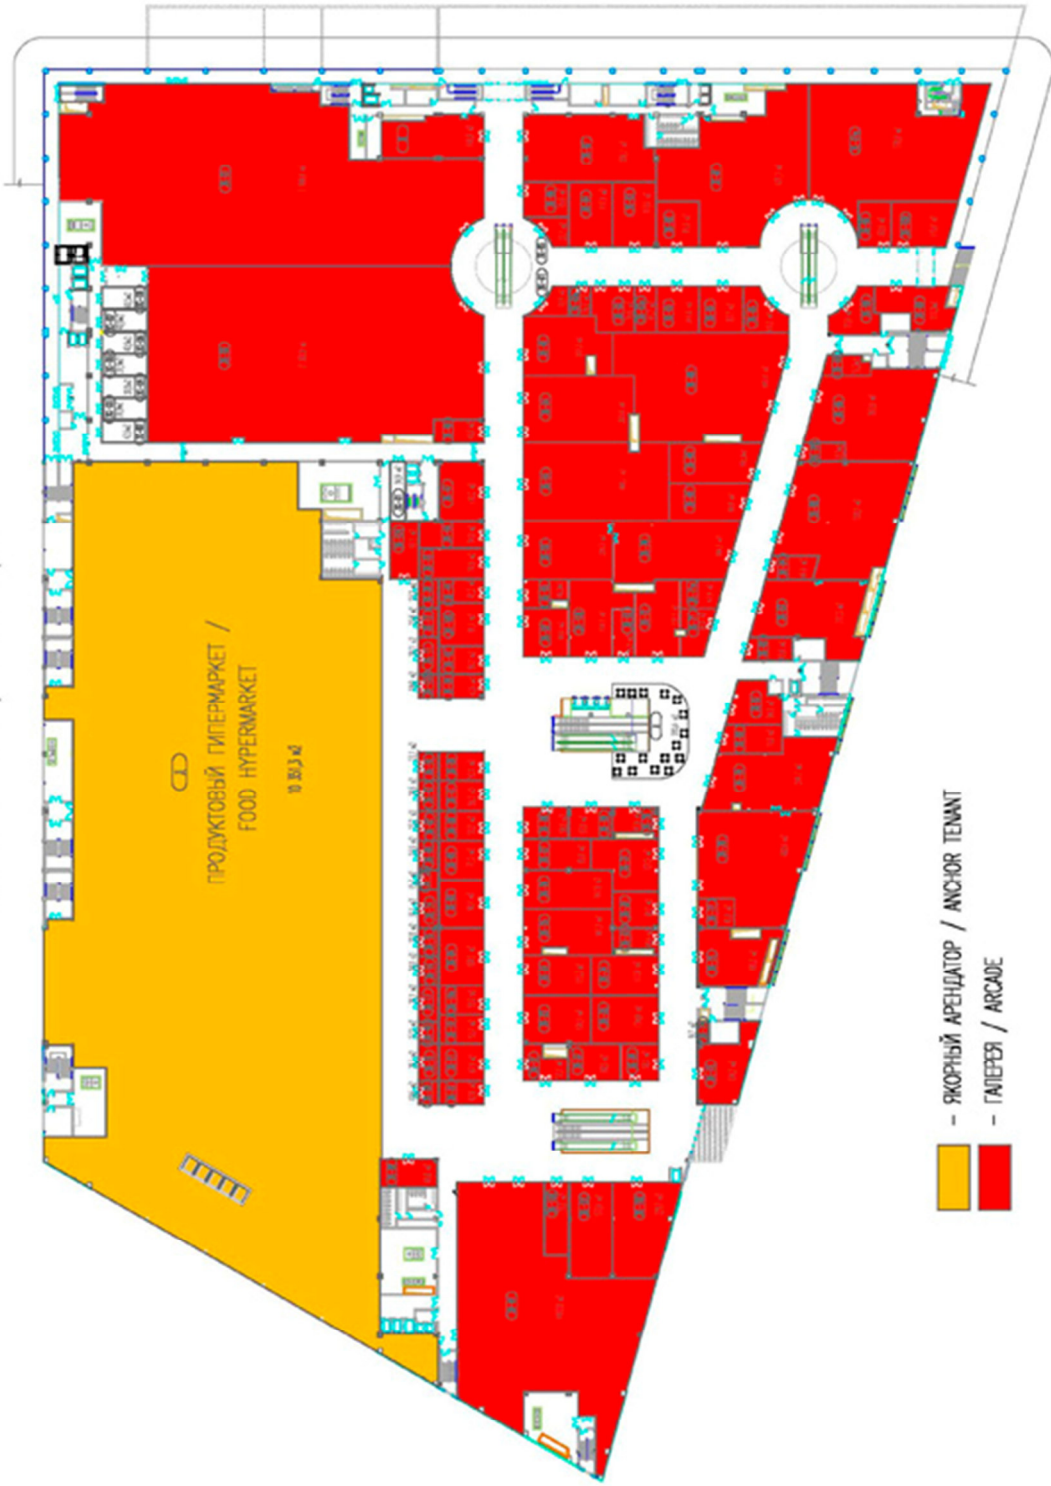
Общий план 1-ого этажа ТРЦ «Шарус» г. Москва
